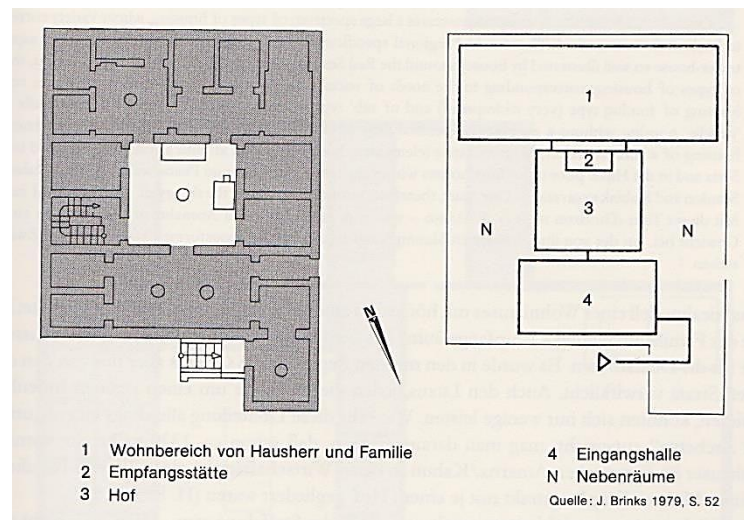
Grundriss eines Innenhofhauses; Quelle: WIRTH 2002³: 369
